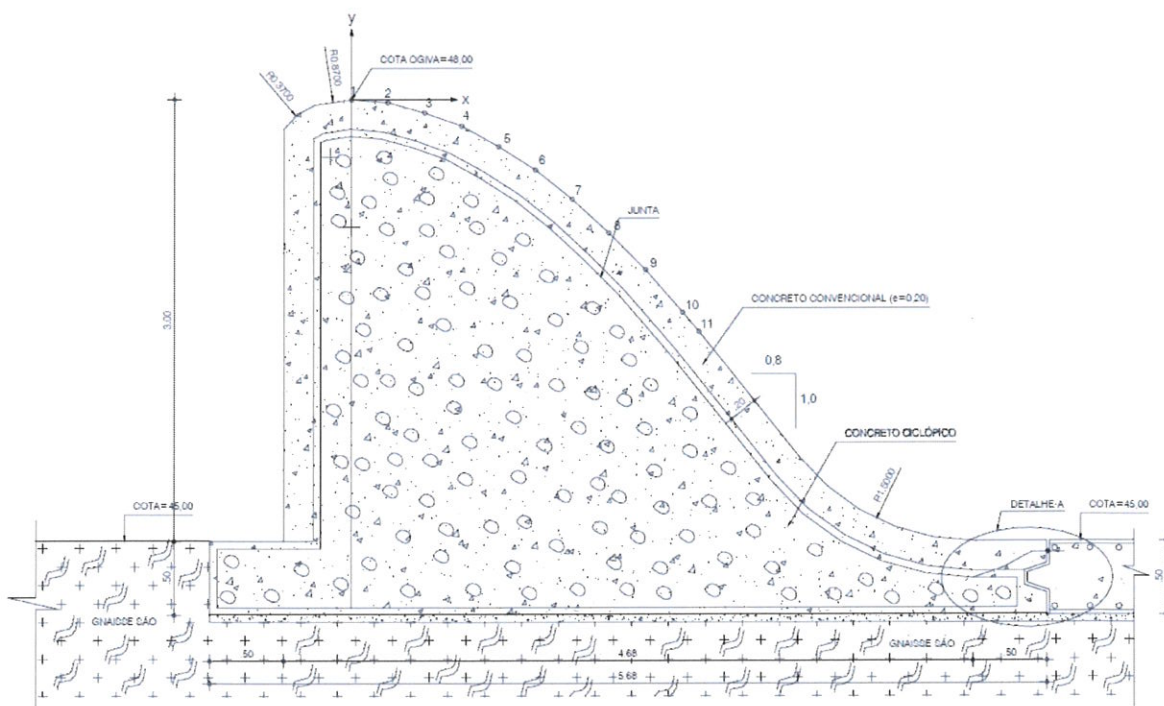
Perfil do vertedouro da Barragem Melancia, conforme projeto executivo.
